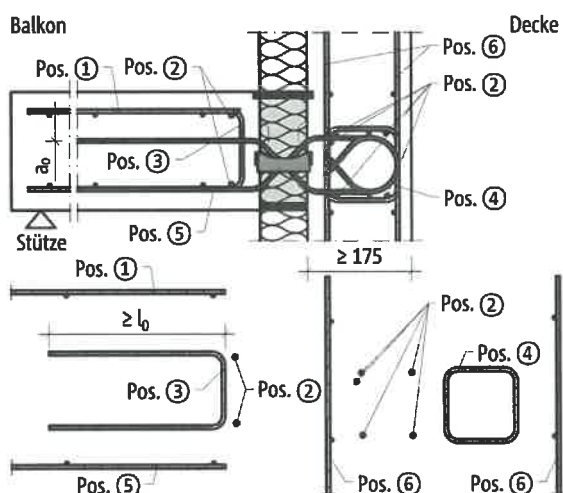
Schöck Isokorb® T Typ Q-VV1 bis -VV5 6.0, in Wand schematisch dargestellt
